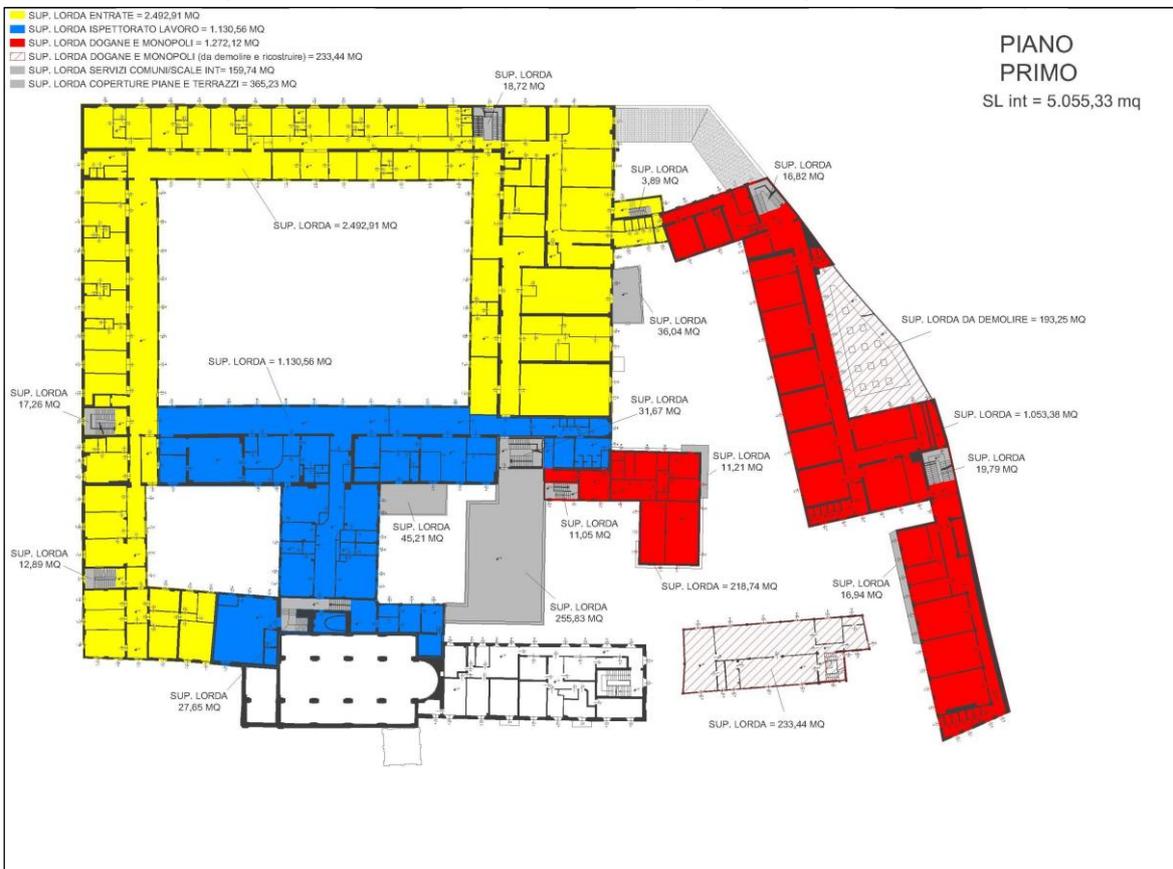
Piano di razionalizzazione (2019) – pianta del piano primo
